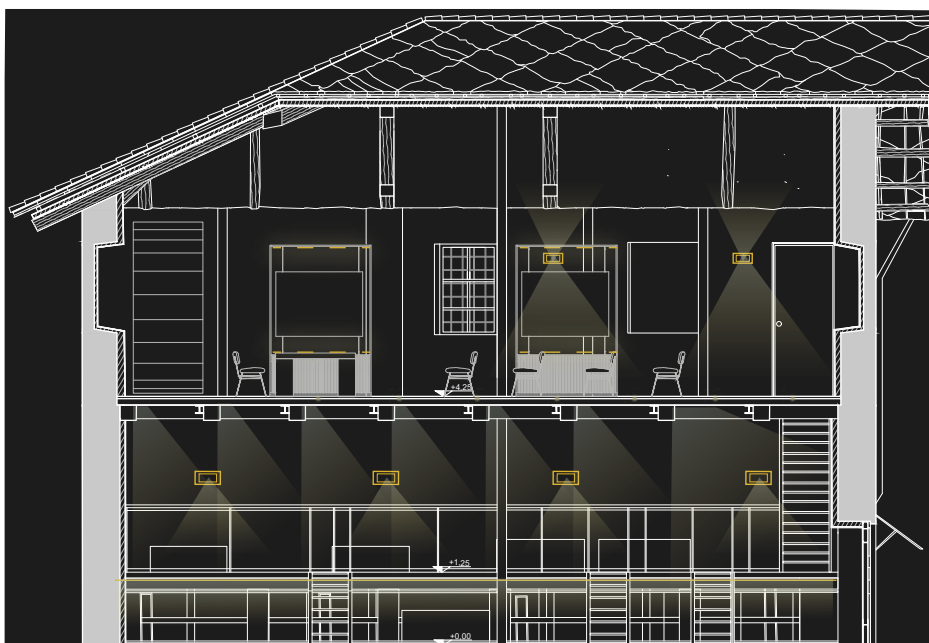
Sezione longitudinale del Mulino dei Benso, progetto illuminotecnico (tav. 12.1).
